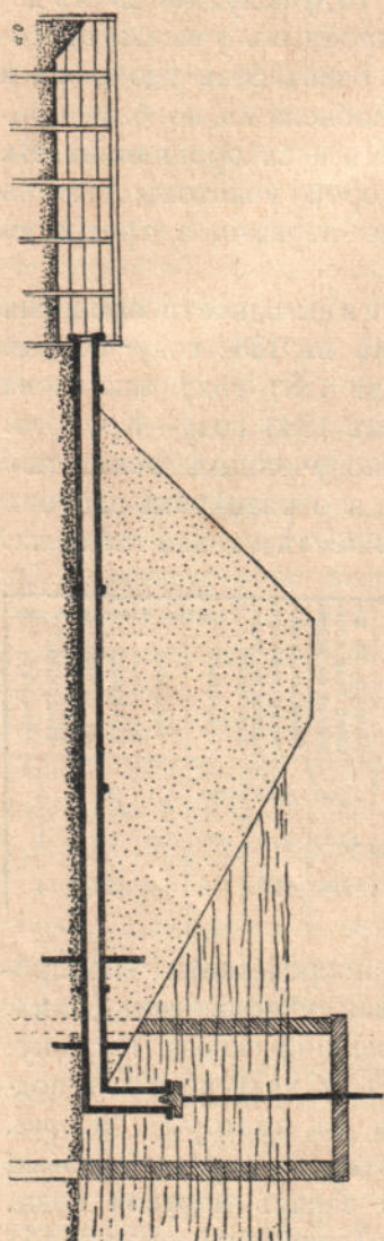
Поперечный разрѣзъ плотины, въ основаніи которой проложена чугунная водопроводная труба.
